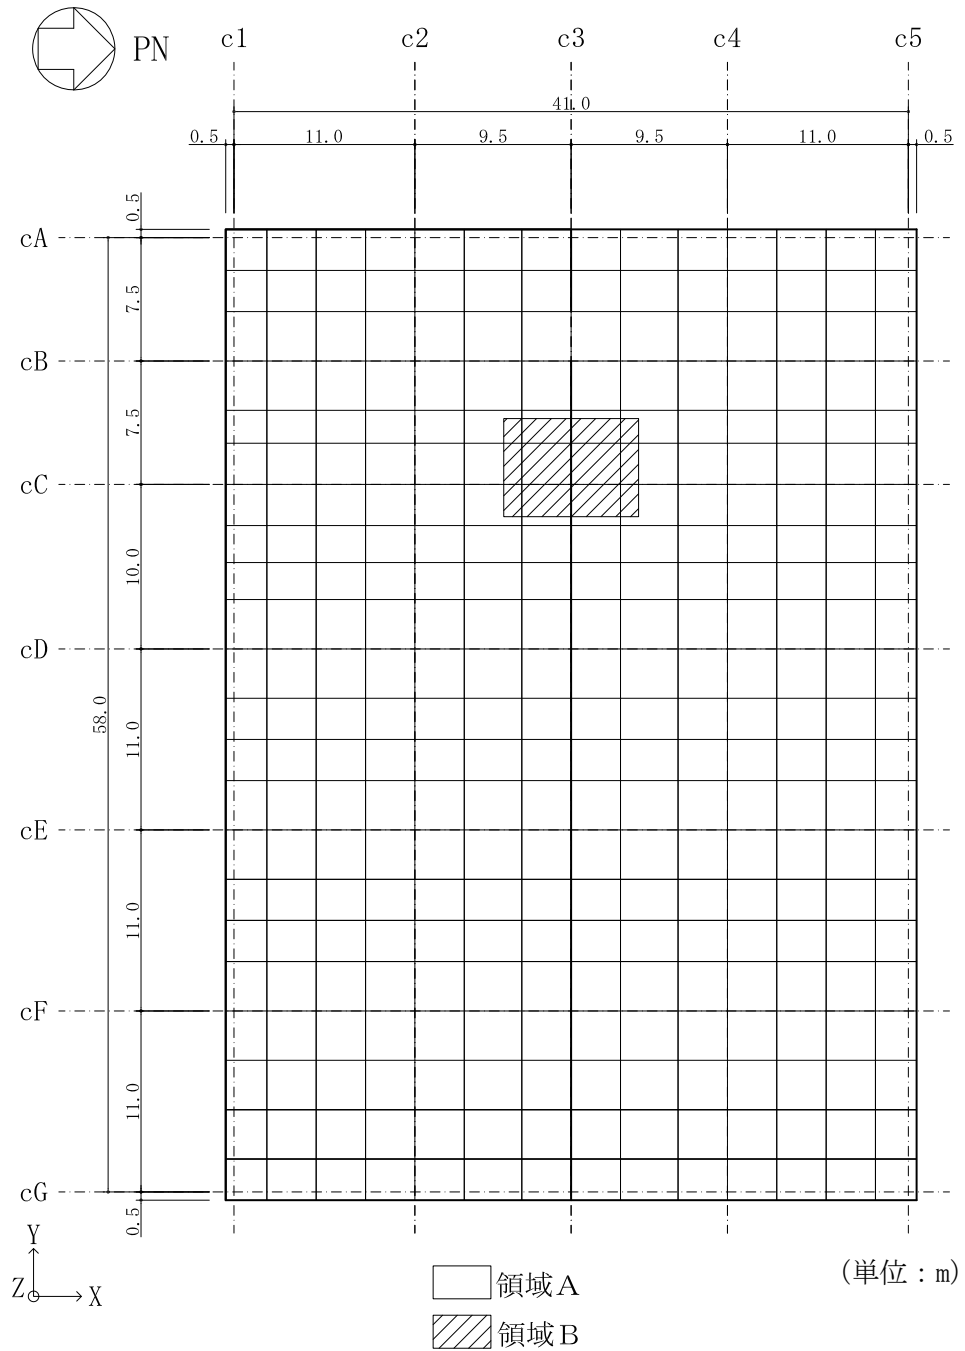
基礎スラブの配筋領域図 (EW 方向, 下ば筋)
